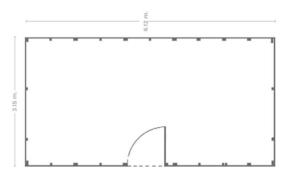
Planta vivienda OSB Tipo 1. Fuente: Fábrica FV.
